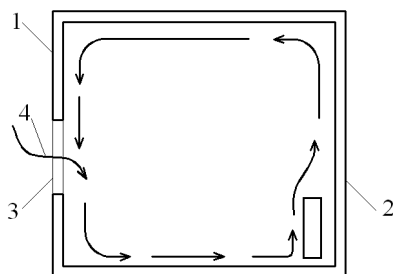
Примерная схема движения воздушных потоков в помещении при размещении отопительных приборов у внутренней стены: 1 – наружная стена помещения; 2 – внутренняя стена помещения; 3 – окно; 4 – поступление наружного воздуха в помещение
